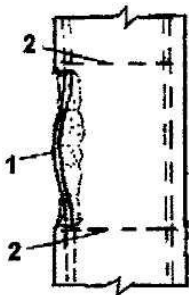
Схема разрушения в сжатой зоне бетона при потере устойчивости стержнями сжатой арматуры:
